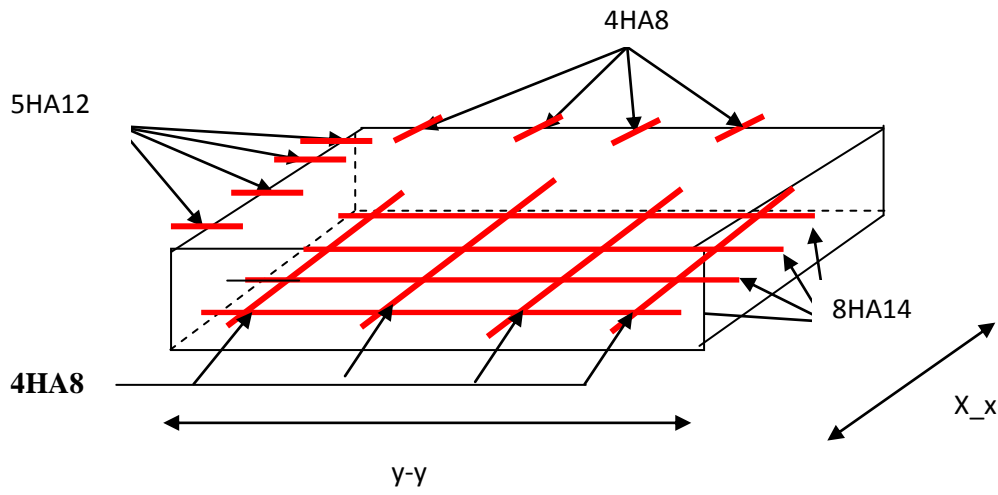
Schéma de ferrailage de la dalle pleine.
